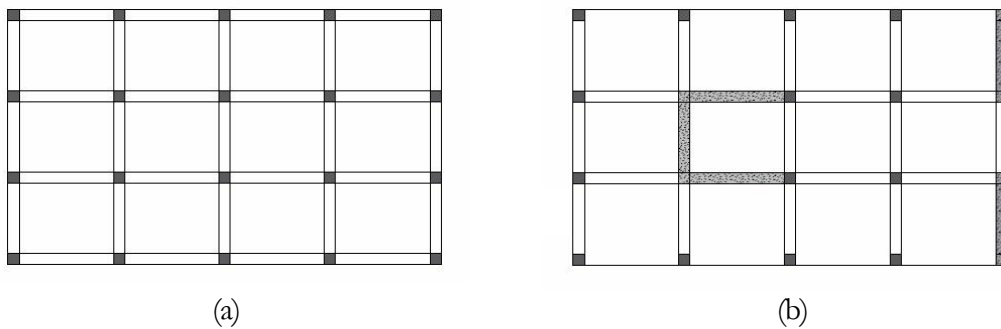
Planta de estrutura em: (a) pórtico e (b) mista (Bhatt, 2007).
